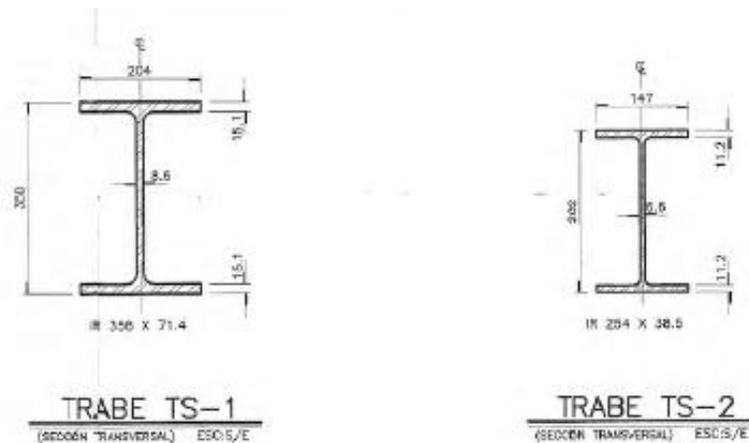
Sección de travesas secundarias trasversales perfil IR TS-1 y Trabe TS-2
